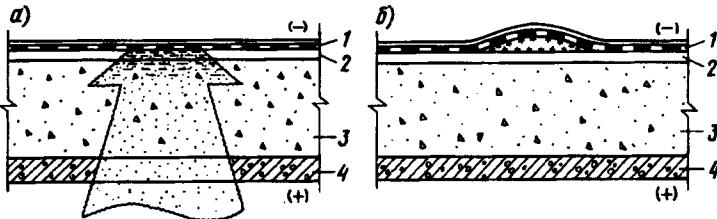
Образование льда под кровельным ковром бесчердачного покрытия
